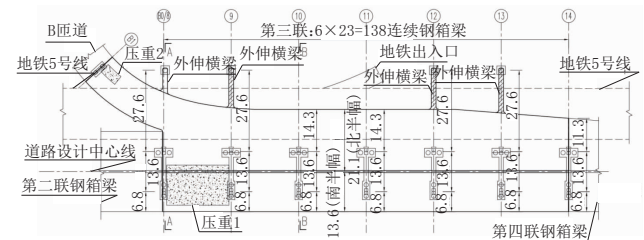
黄埔大道支线第三联钢箱梁平面布置图(单位:m)
